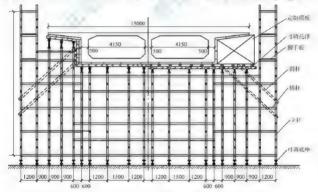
现浇箱形截面钢筋混凝土桥梁模板支撑架 (单位: mm)
